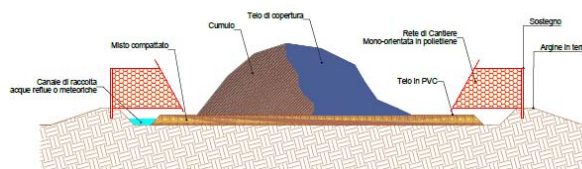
Sezione tipo stoccaggio terre e rocce da scavo.
